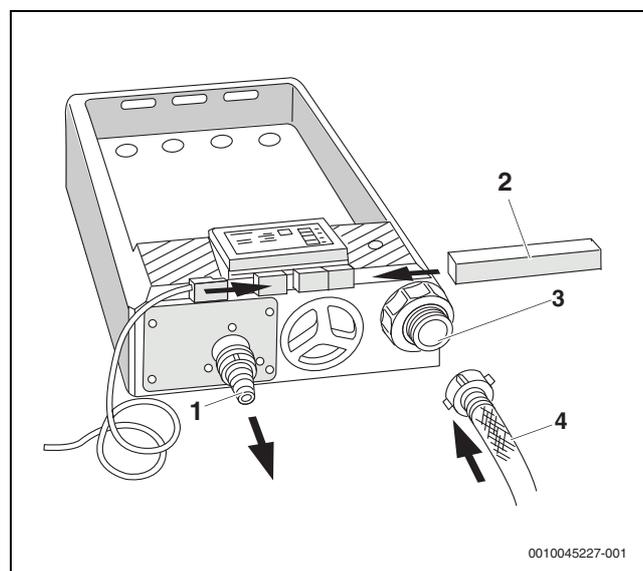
Zulaufschlauch EKO bzw. Ablaufschlauch AKO anschließen
